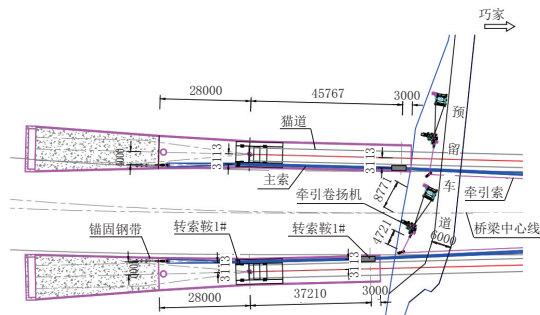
宁南岸缆索吊主索锚固平面布置位置示意图(单位:mm)
